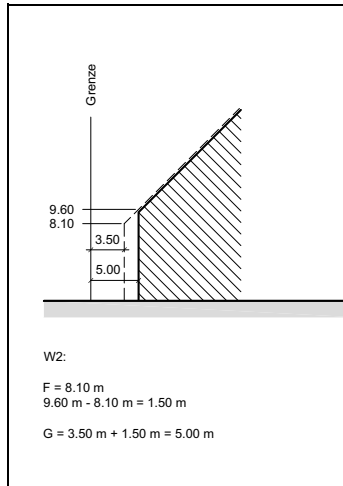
Grenzabstand eines abgerundeten Baukörpers (§§ 21–26 ABV)
